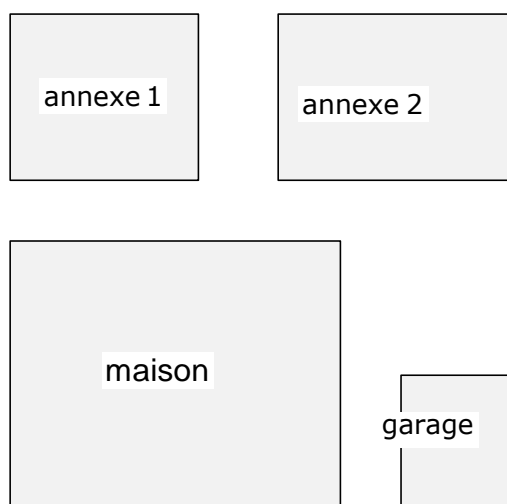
exemple d'un bâtiment de forme complexe se composant de sous-structures indépendantes
